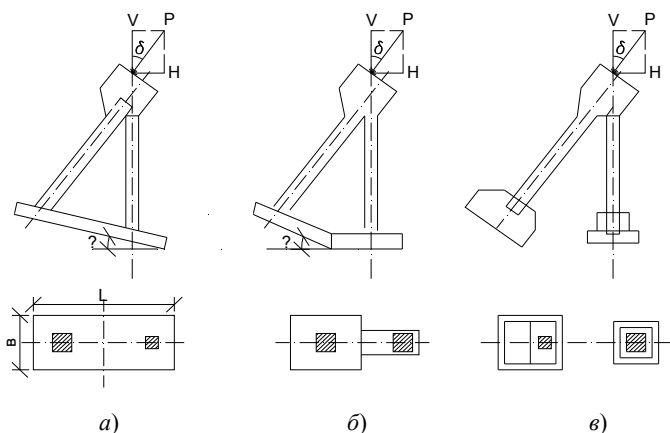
Схема монолитных (а); сборных (б); рамных (в) фундаментов
